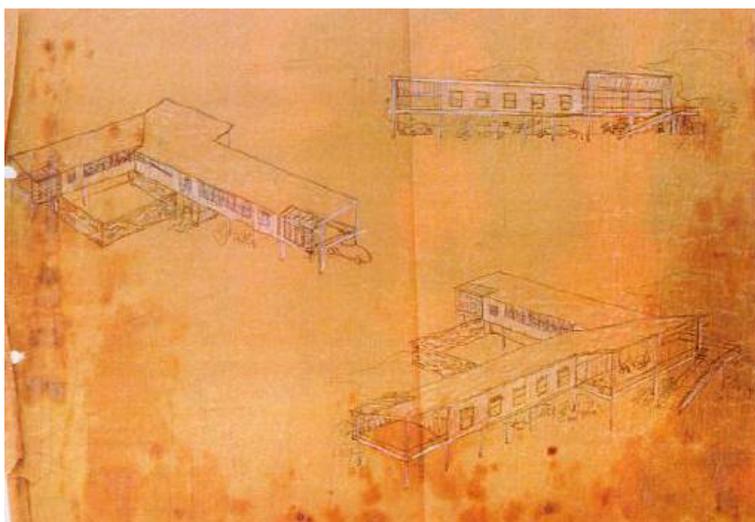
Fachada nordeste da casa do Barão de Saavedra (Petrópolis, 1942/44).
